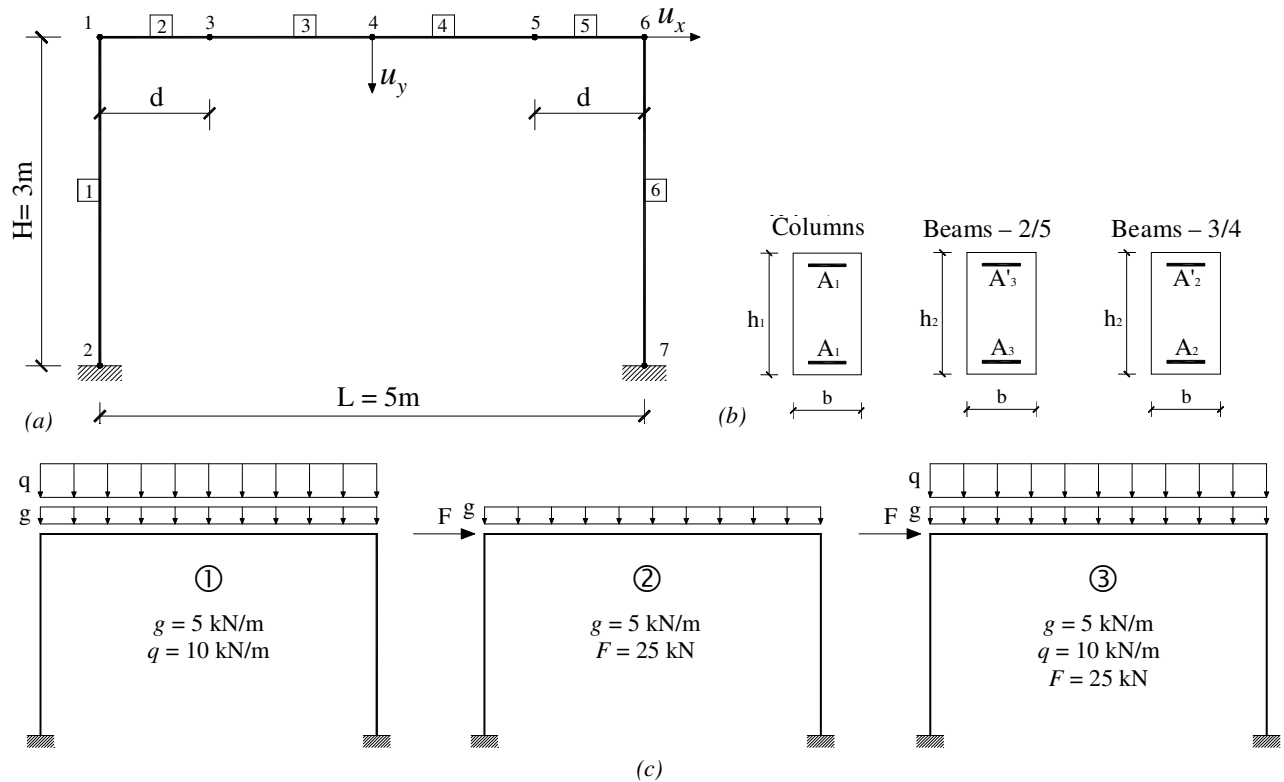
Telaio in calcestruzzo armato: (a) dimensioni e schema strutturale; (b) sezioni di pilastri e trave; (c) condizioni di carico.
